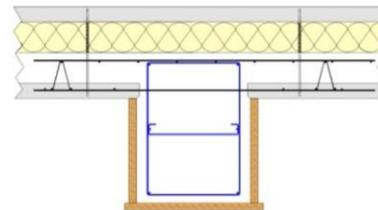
Poteau coulé en place au droit d'un joint vertical
